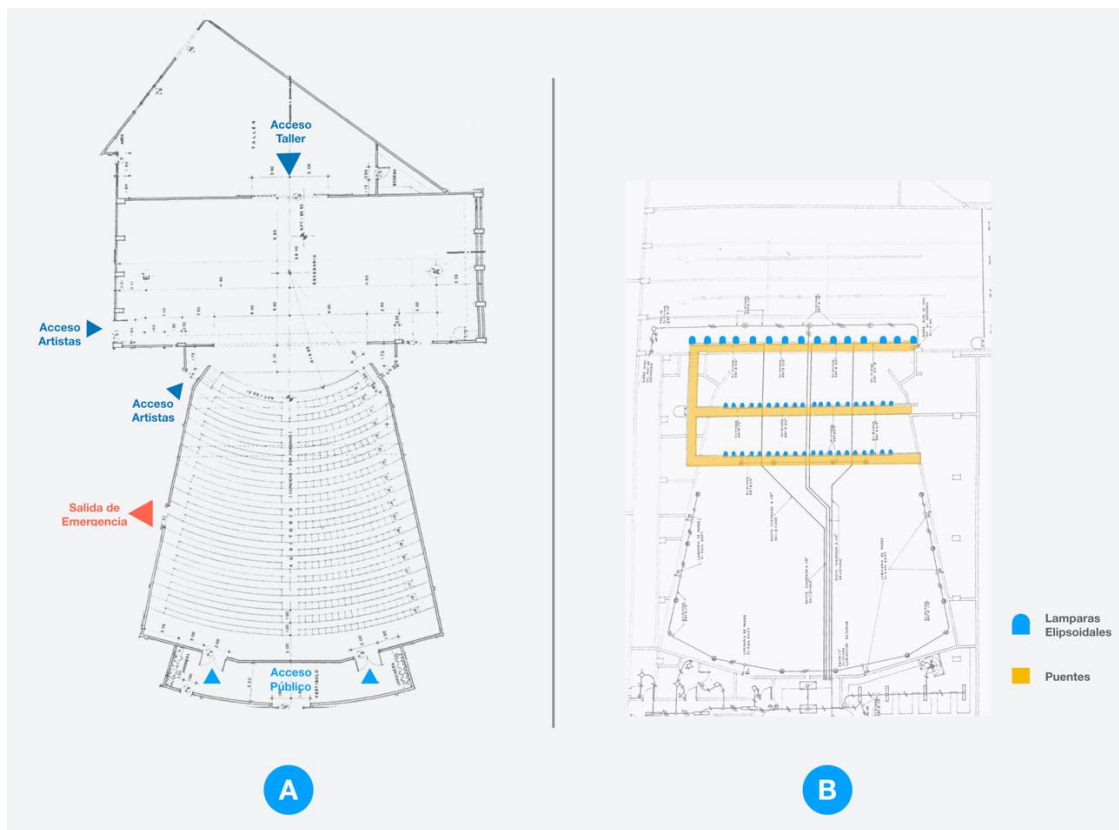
A: Planta de accesos, B: Planta de cielo falso
